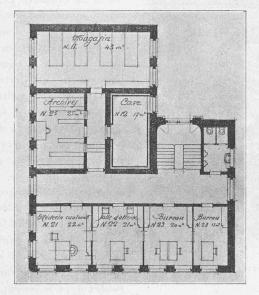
Plan du rez-de-chaussée inférieur. — 1:300.
